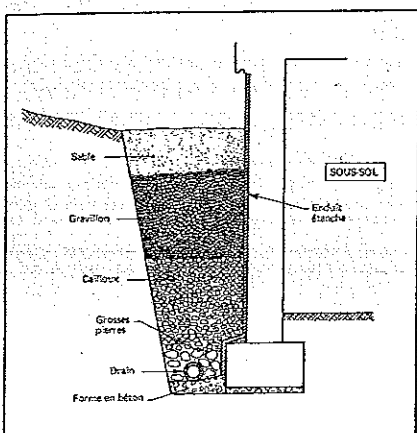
Tranchée drainante pour collecter les eaux de ruissellement de surface (Extrait du DTU 20-11)
